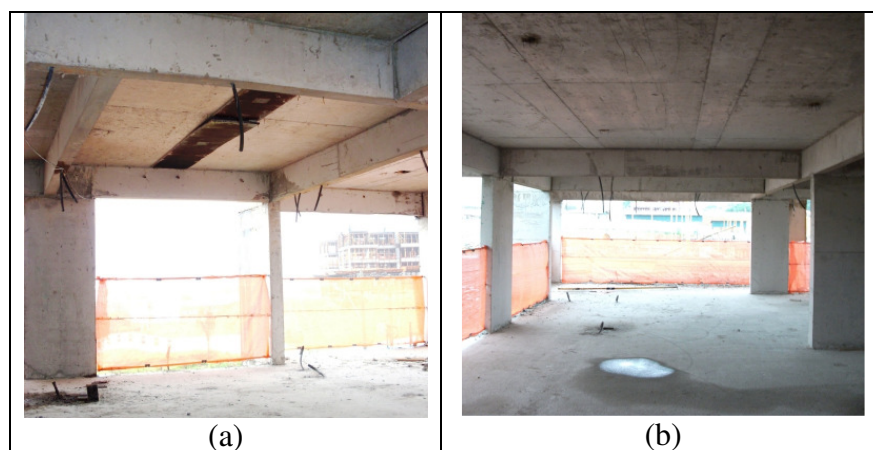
fotos ilustrativas da retirada do reescoramento das vigas e lajes
